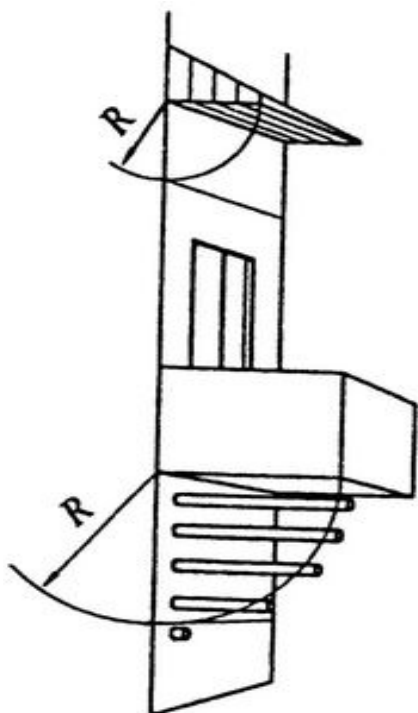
Размещение отверстий дымовых каналов на фасаде здания
